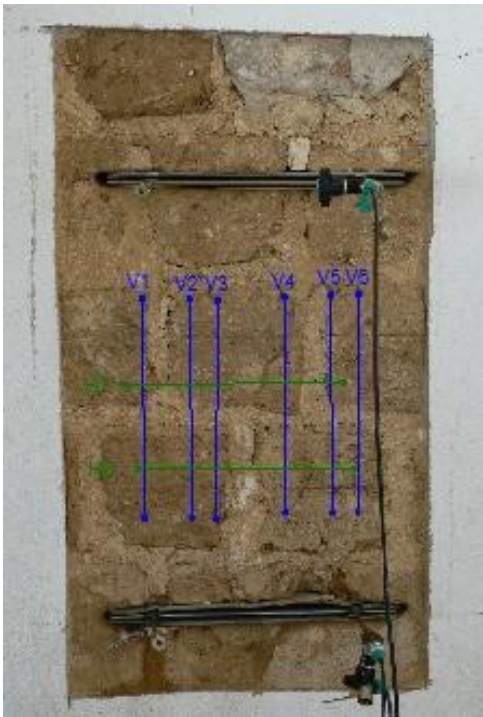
Alinhamentos verticais e horizontais da Janela 2 (Santarém)
